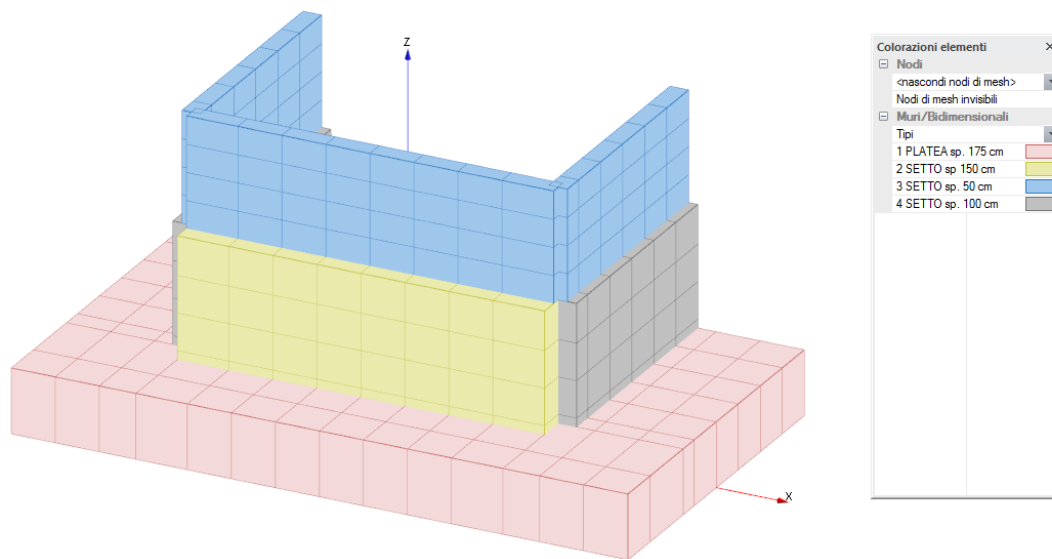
VISTA TRIDIMENSIONALE SOLIDA MODELLO SPALLA 1 – LATO VALLE
